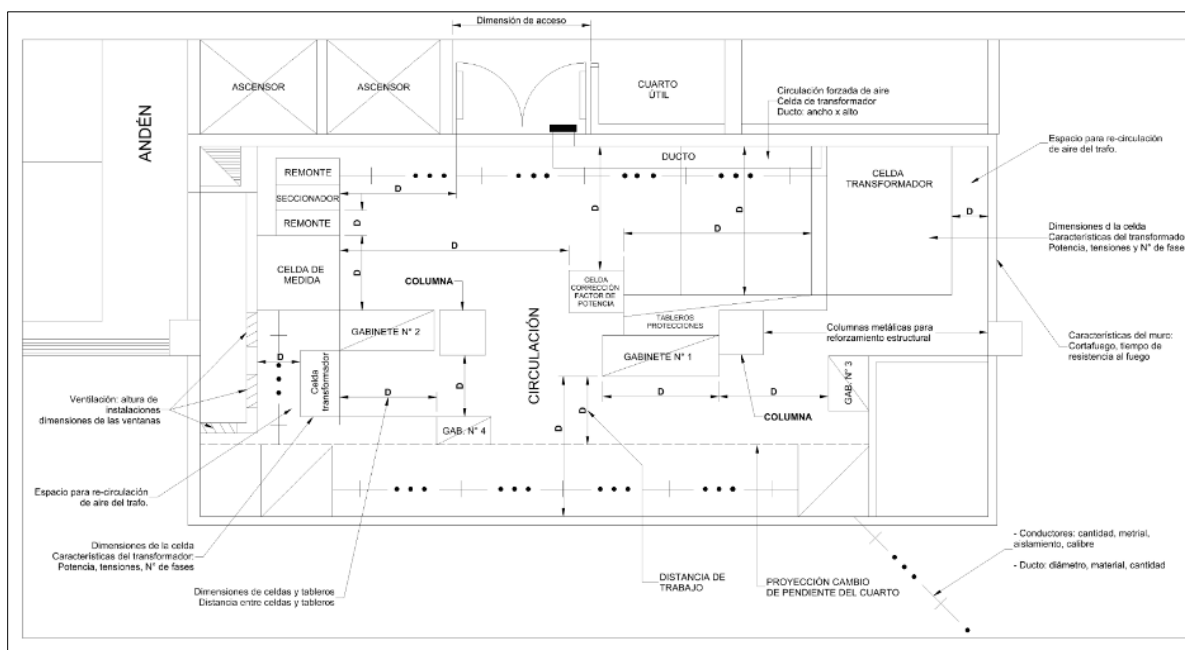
Ejemplo de vista en planta – Cuarto eléctrico
